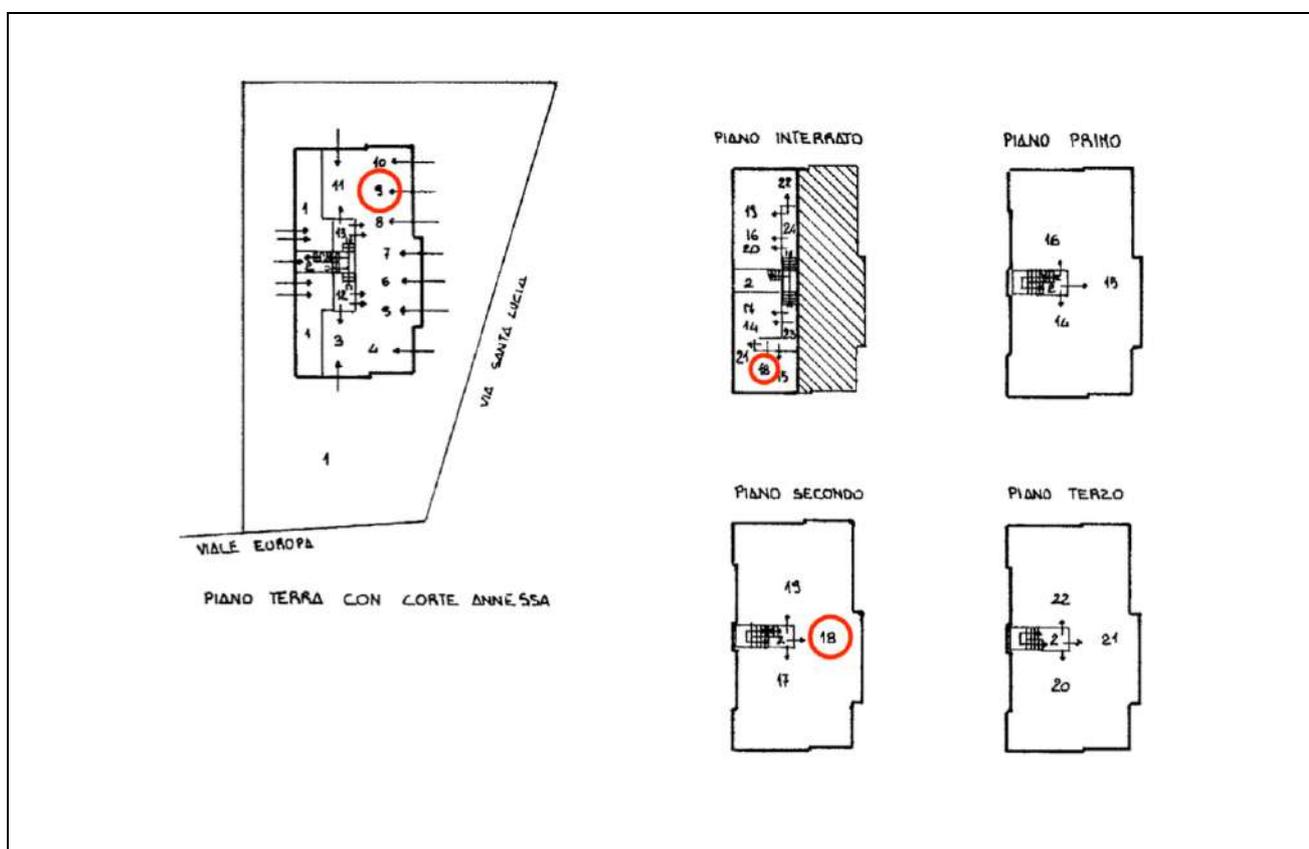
Estratto elaborato planimetrico dei beni (non in scala).
